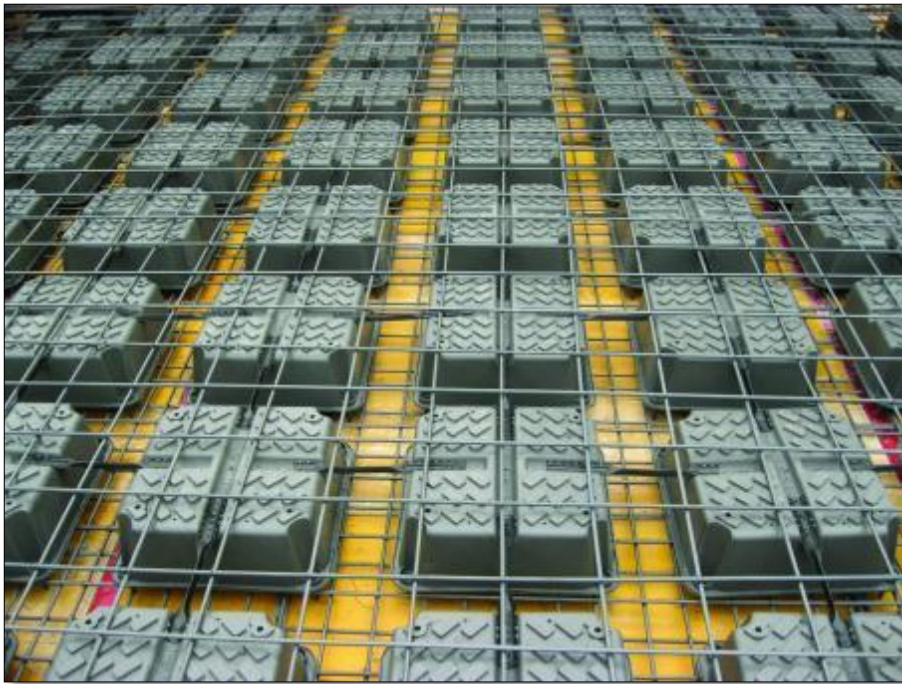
Armação de laje *U-Boot Beton*, com altura do elemento de 10 cm (DALIFORM GROUP, 2015).
